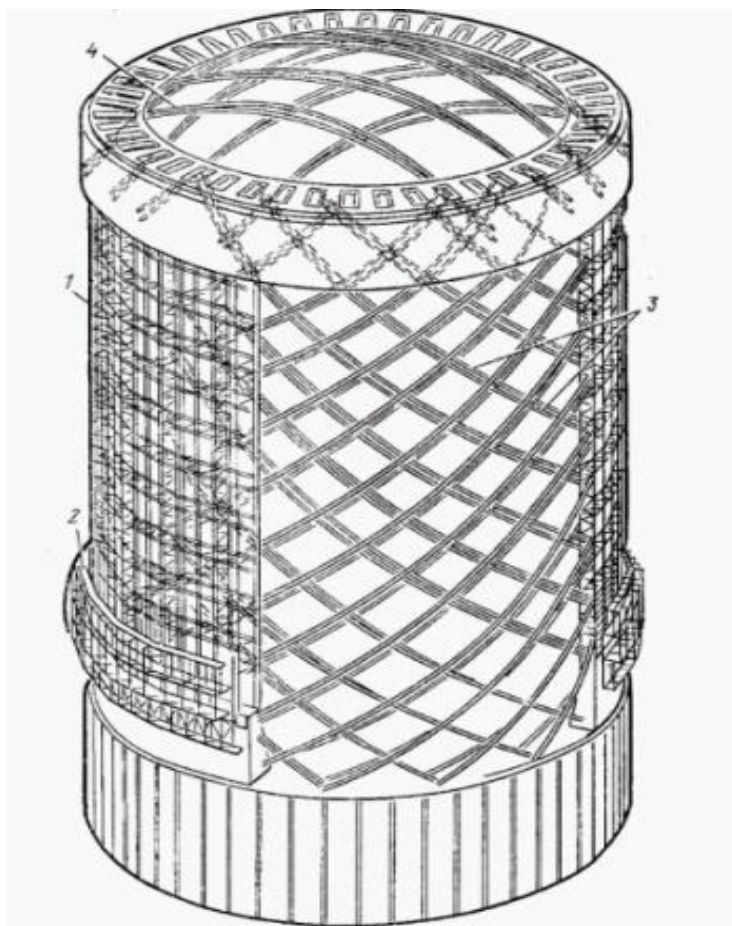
Схема возведения цилиндрической части оболочки и расположения каналообразователей: 1 – армокаркас; 2 – опалубка; 3 – полиэтиленовый каналообразователь цилиндрической части; 4 – полиэтиленовый каналообразователь купола
